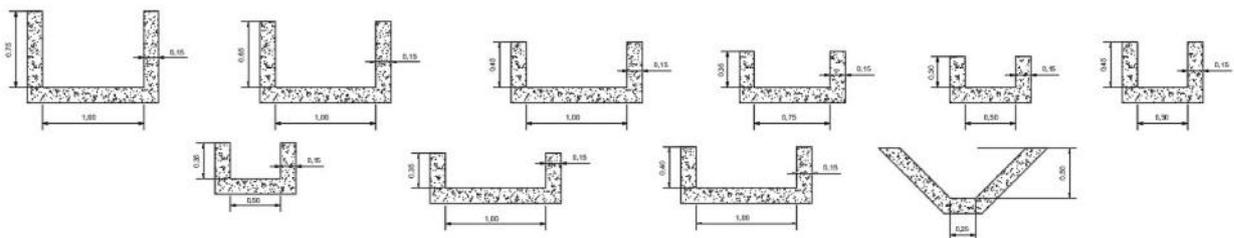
Perfiles tipo de Cunetas Proyectadas Interior del Parque
